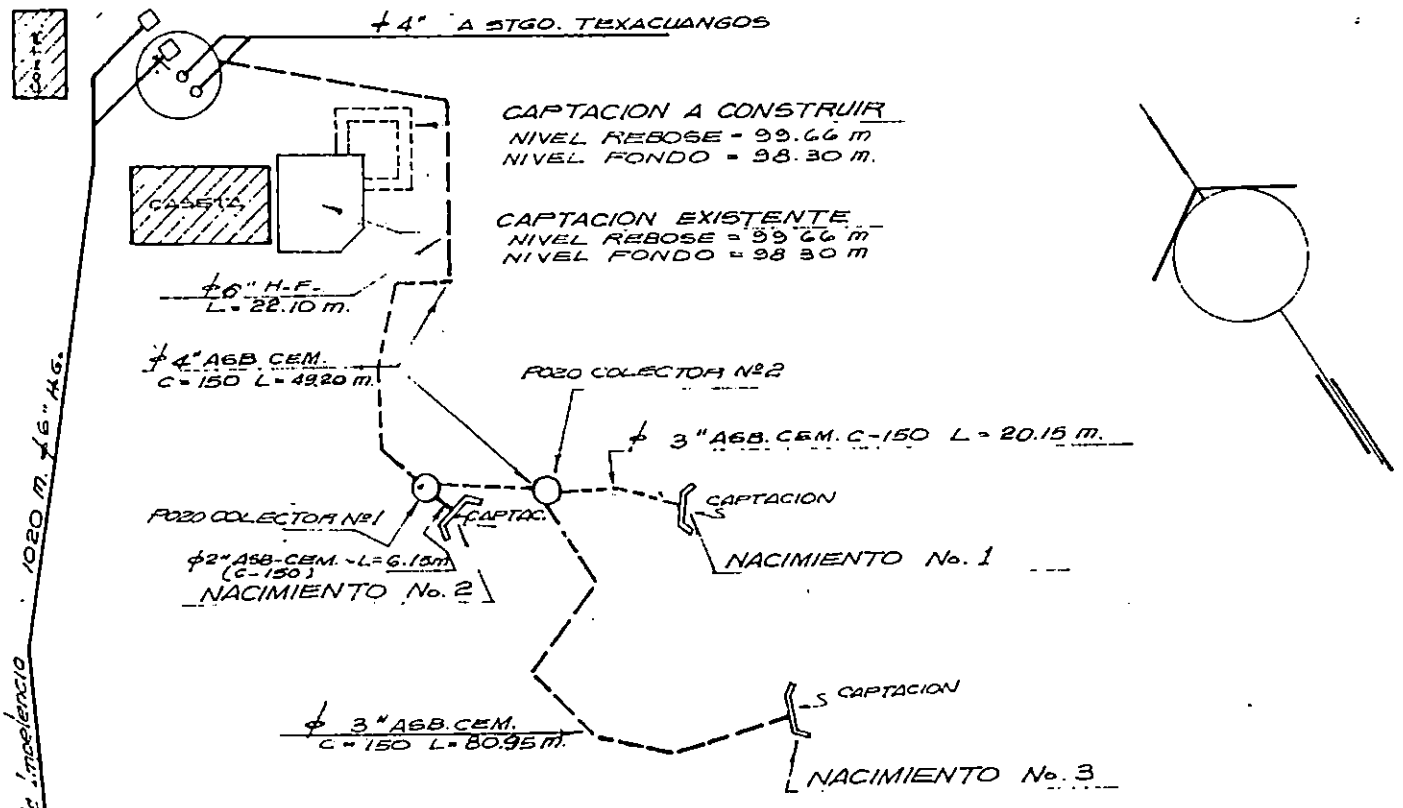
UBICACION DE PLANTA DE JUTIAPA.
